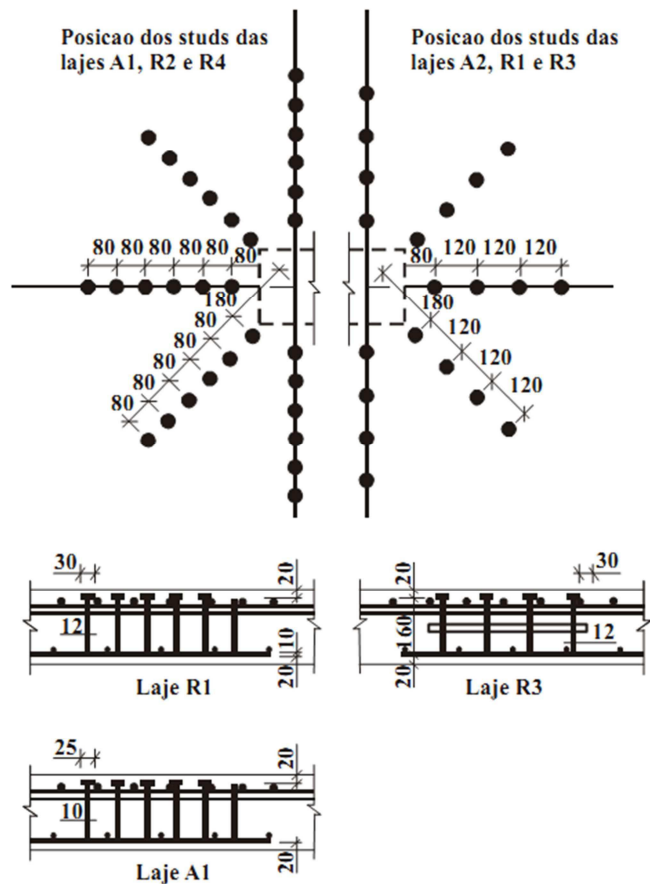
Detalhe da armadura de cisalhamento utilizada nas lajes R1 a R4, A1 e A2 (Regan e Samadian, 2001)
